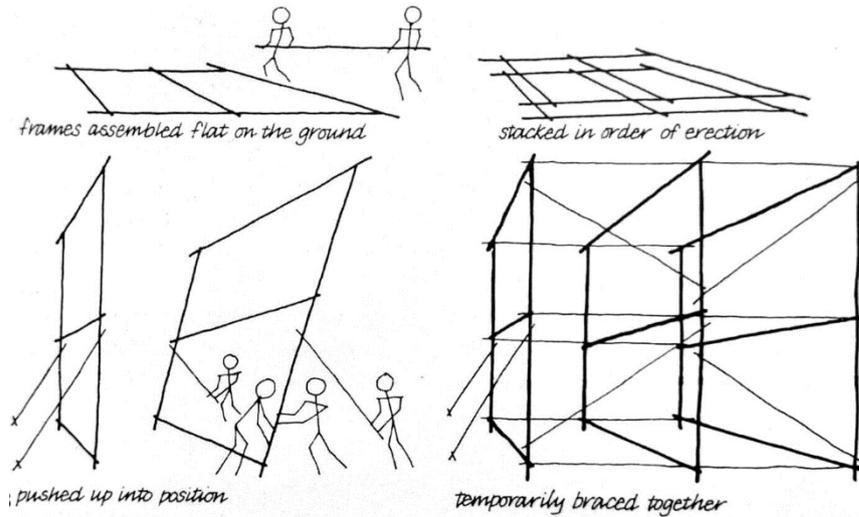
Diagramas de Walter Segal con instrucciones para la autoconstrucción.
